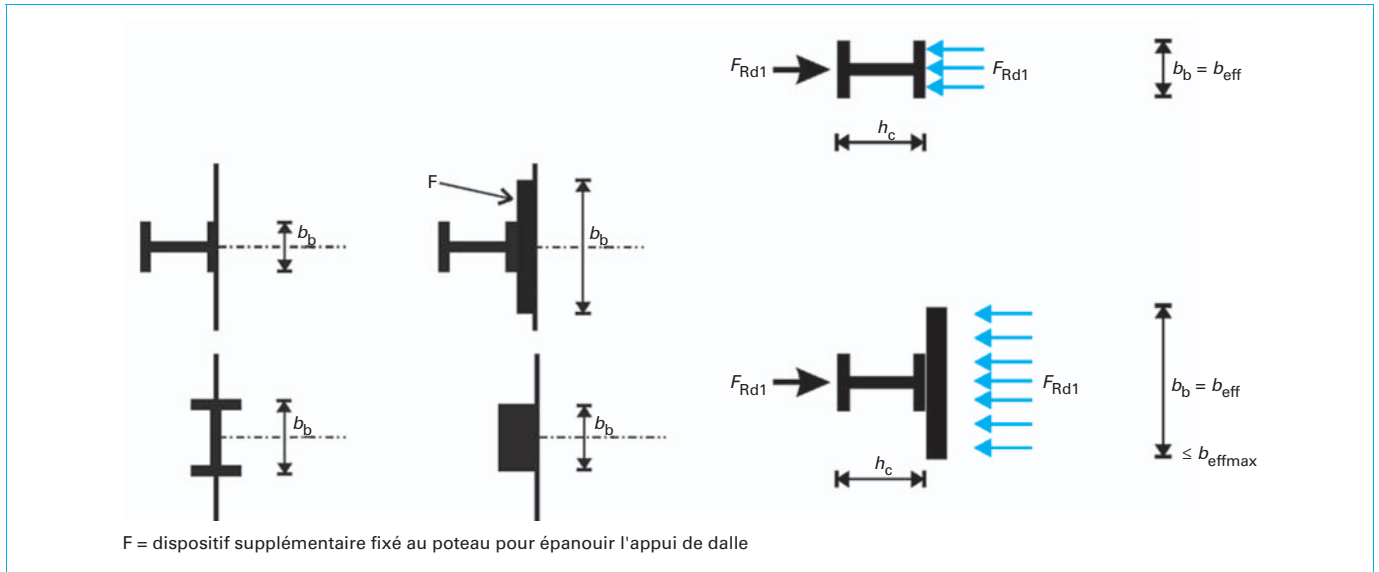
Mécanisme 1 : compression directe sur la face du poteau avec épanouissement éventuel
